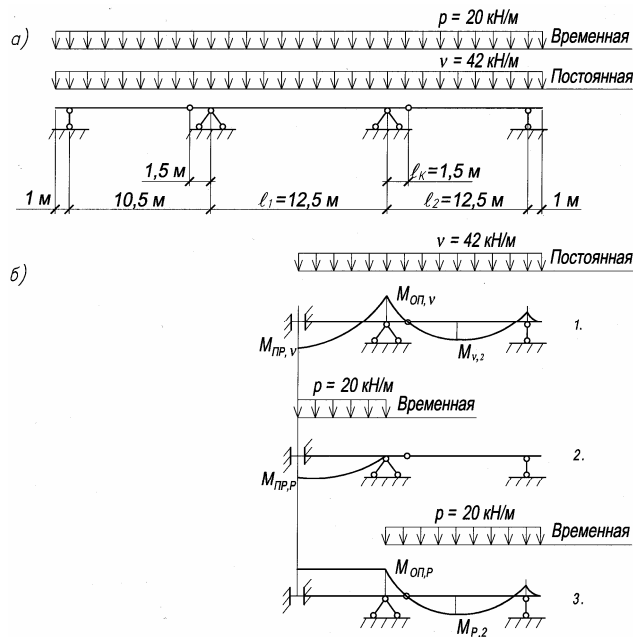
Расчетная схема одной нитки балок (а); расчетные схемы балок для расчета ординат огibaющей эпюры (б)
